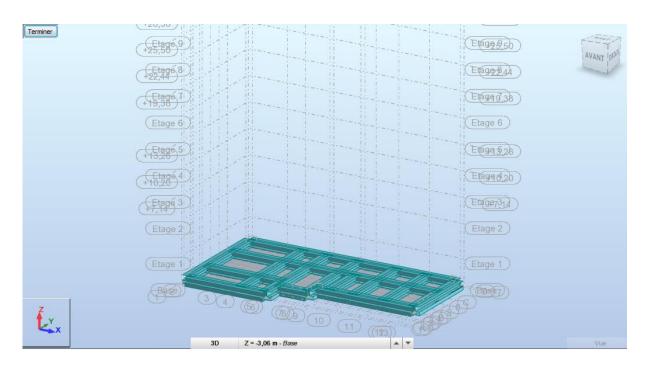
modélisation du radier et les poutres radiers en 3D
